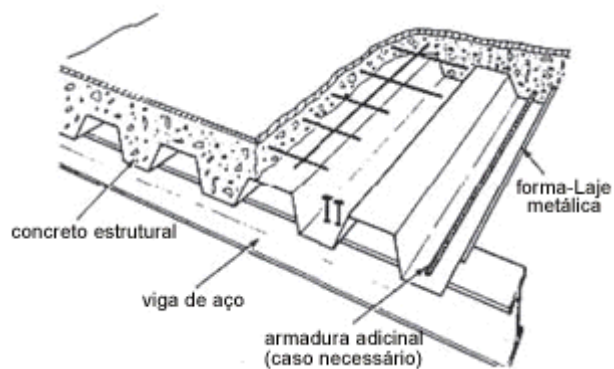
3 Laje mista de aço-concreto “Steel Deck”.
